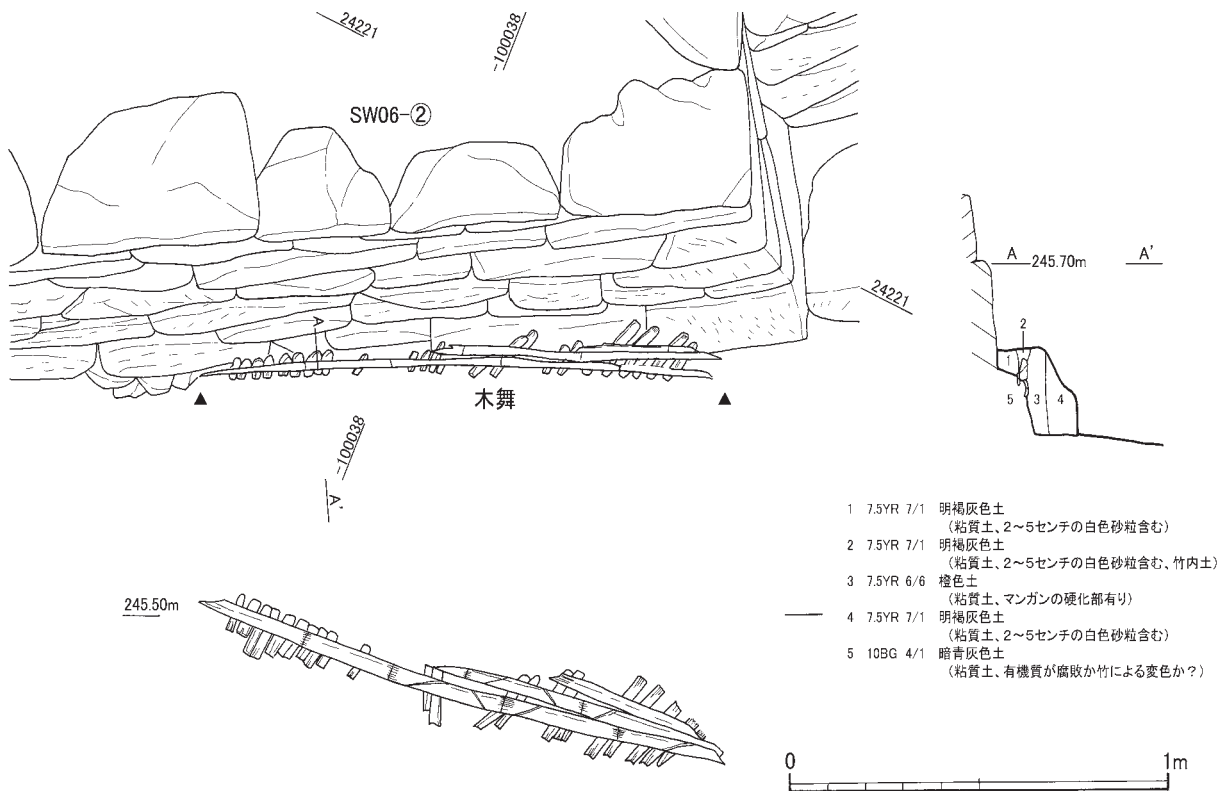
昆布山谷地区第8地点木舞平面図・立面図・土層断面図 (S = 1 / 20)
